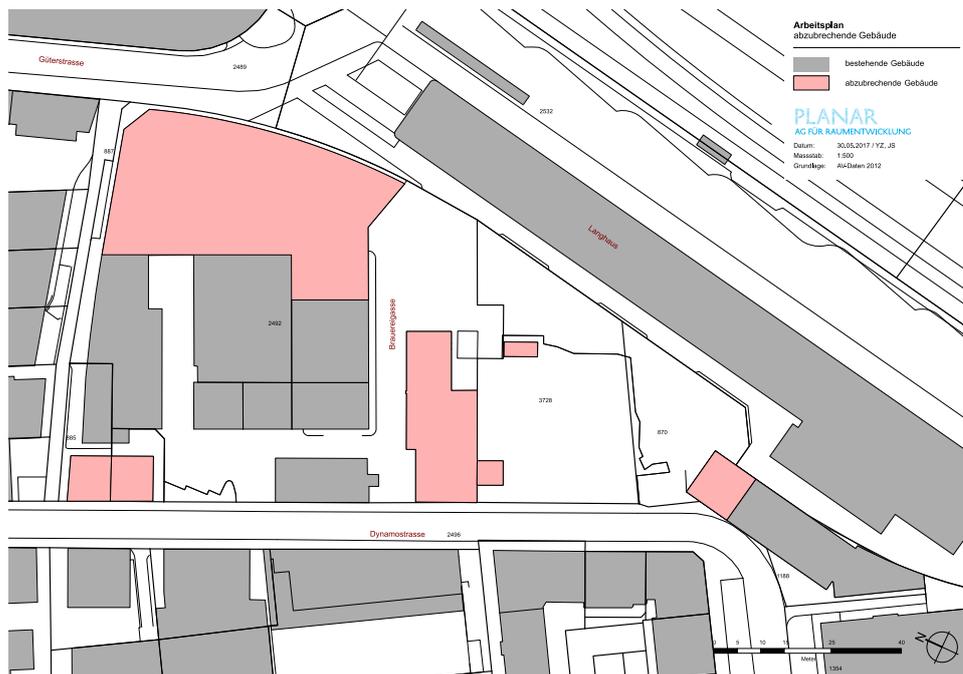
Abzubrechende Gebäude (Quelle: PLANAR 2017)
